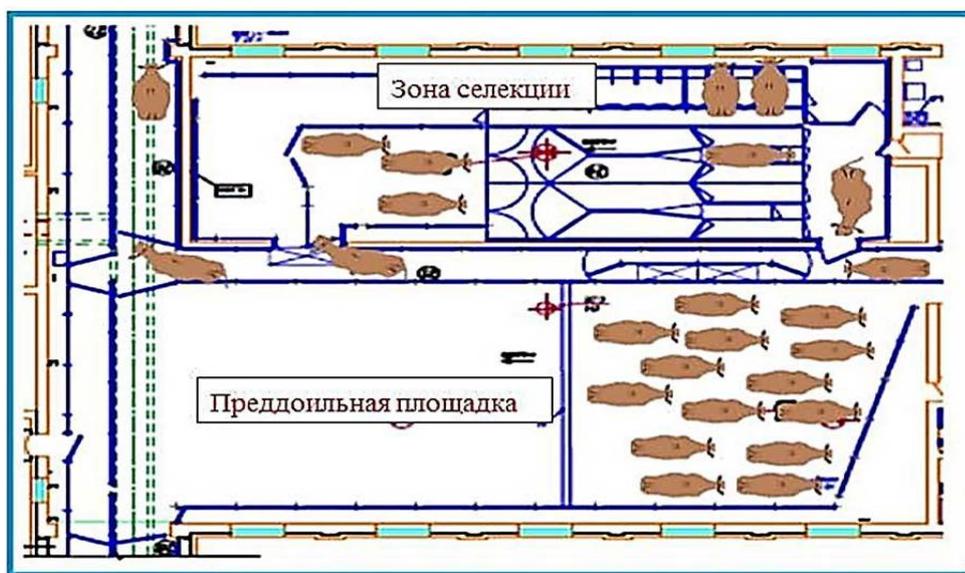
Схема планировки преддоильной площадки с селекционной зоной
